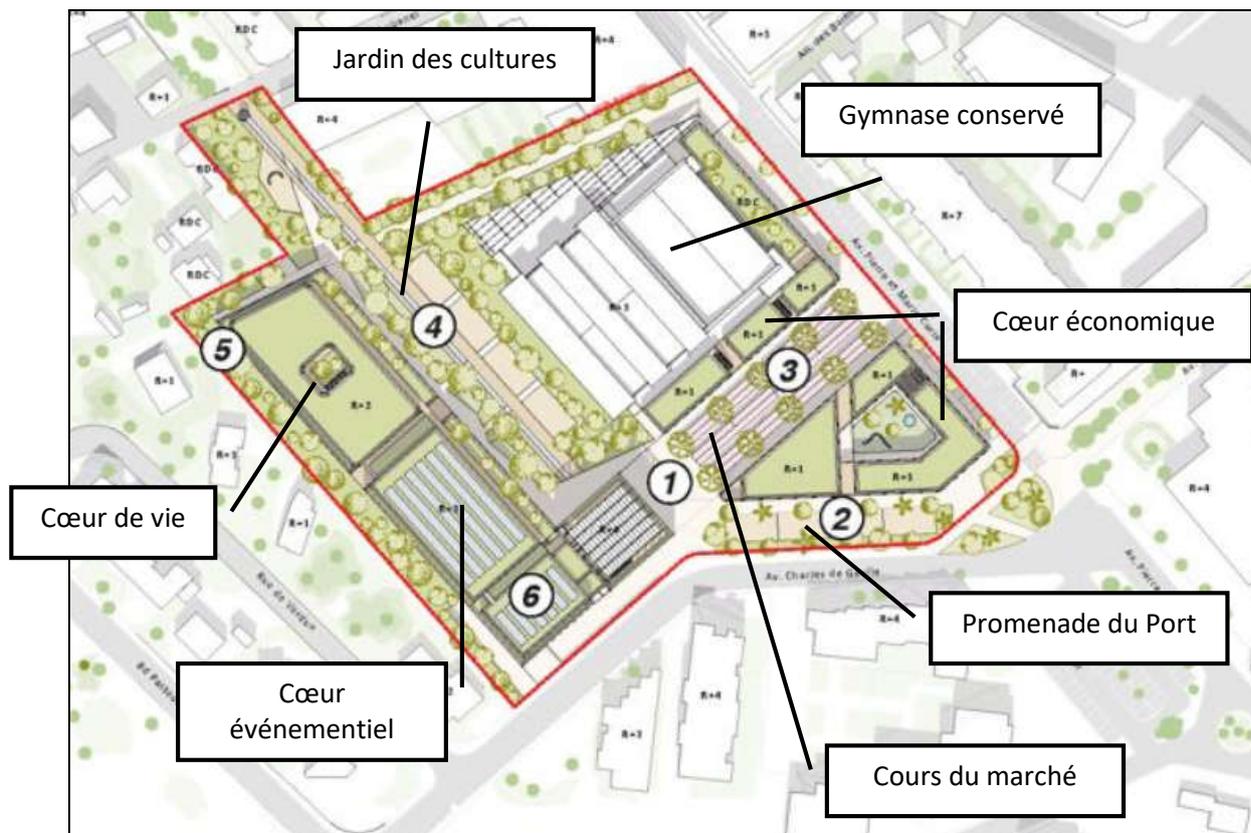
Plan des aménagements (Source : Atelier du Pont, 2024)
